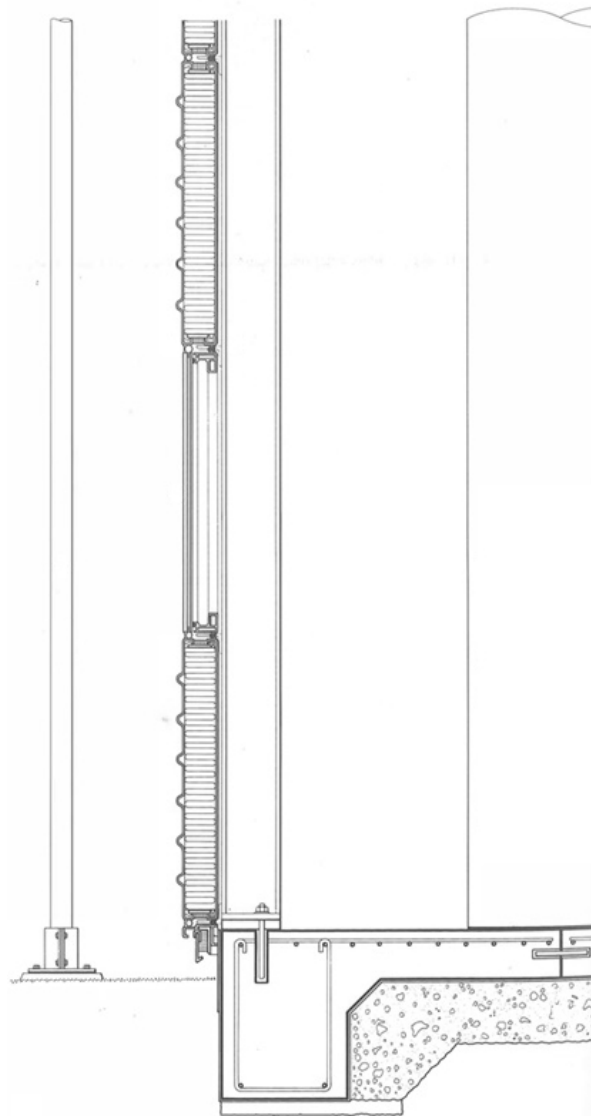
Detalle constructivo del cerramiento del sótano
